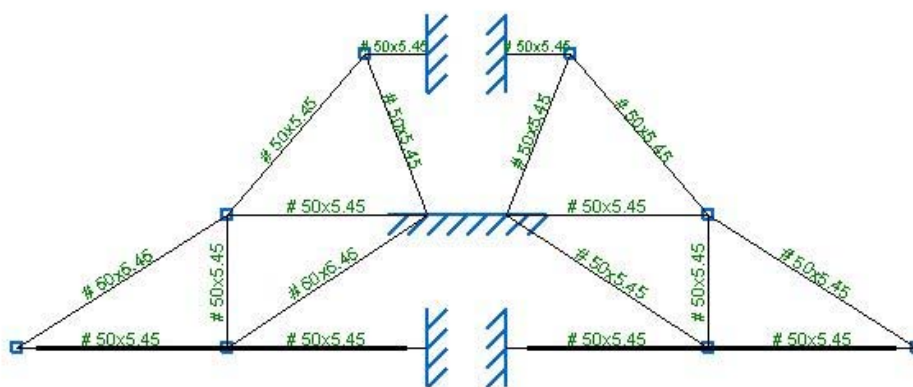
“Secciones del pórtico principal con diseño alternativo”
